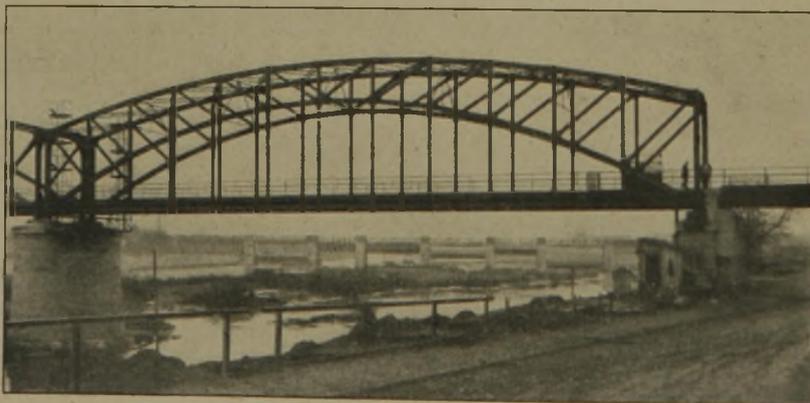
Staustufe Wieblingen. Um 24 m gehobene eiserne Eisenbahnbrücke. Im Hintergrund Gesamtansicht des Wehrs (4 Öffnungen mit Walzen, 2 mit Schützen).
